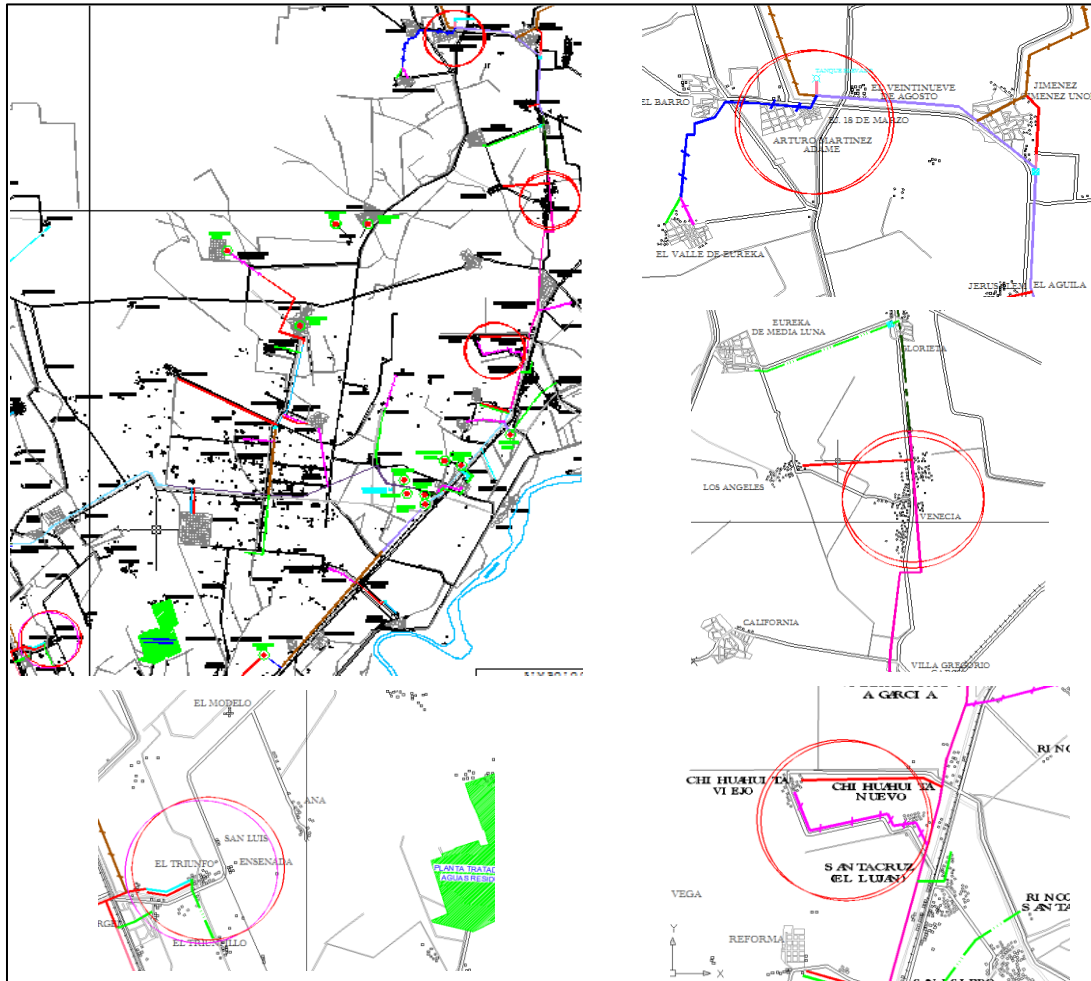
Ubicación de las Plantas de Tratamiento
